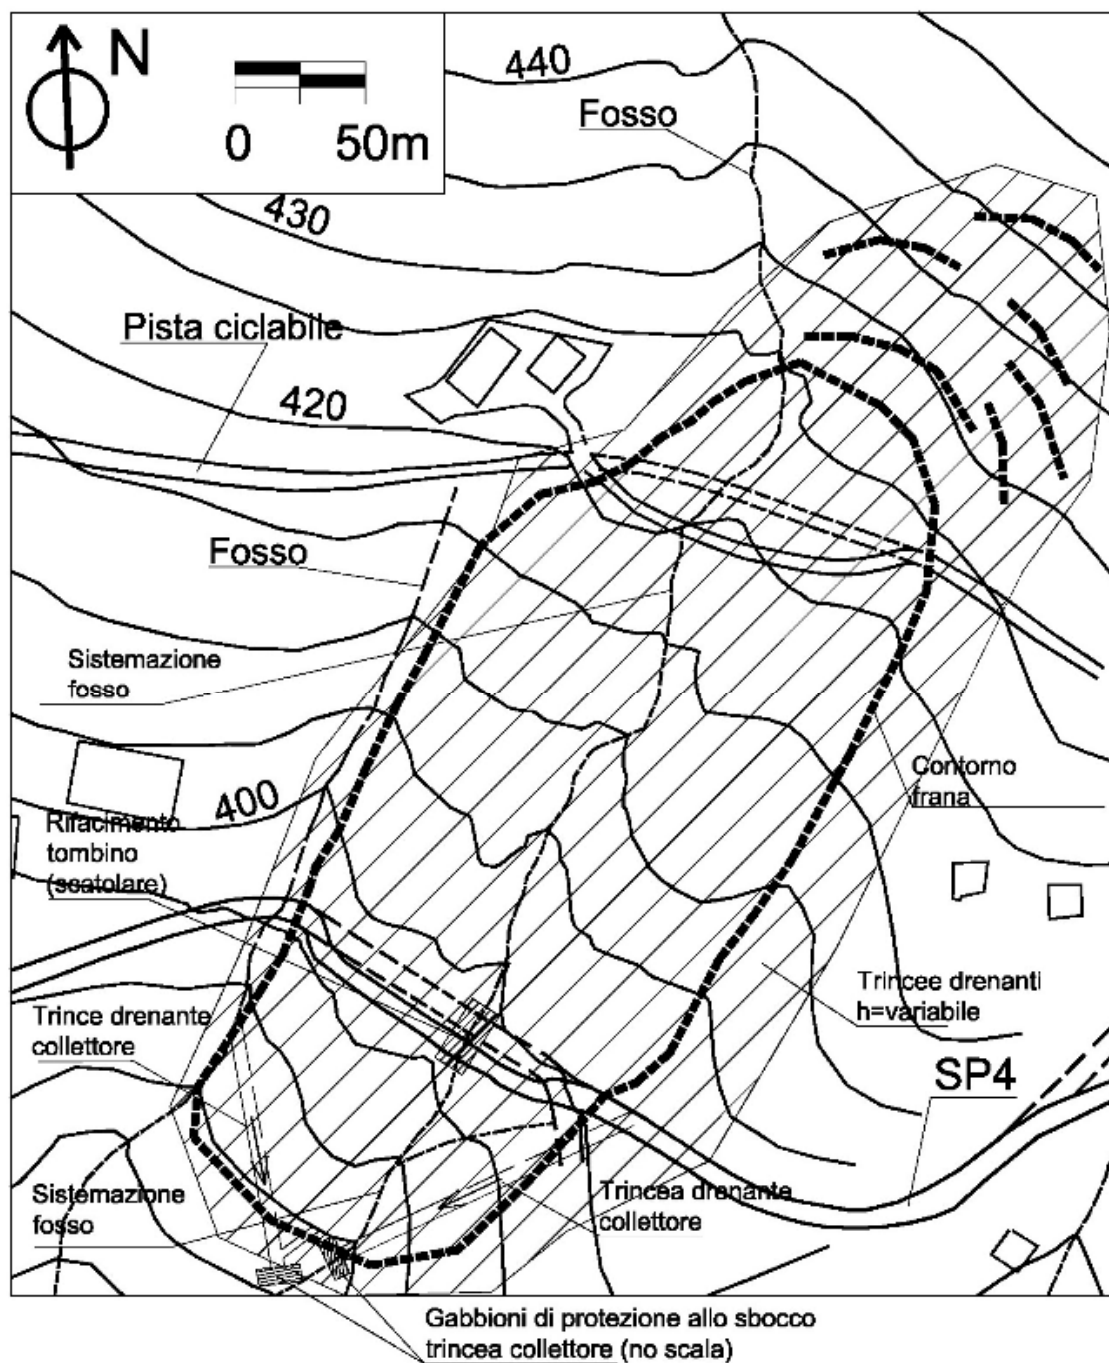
Dissesto al km 22+700. Planimetria con indicazione dell'area in cui realizzare le trincee drenanti.
